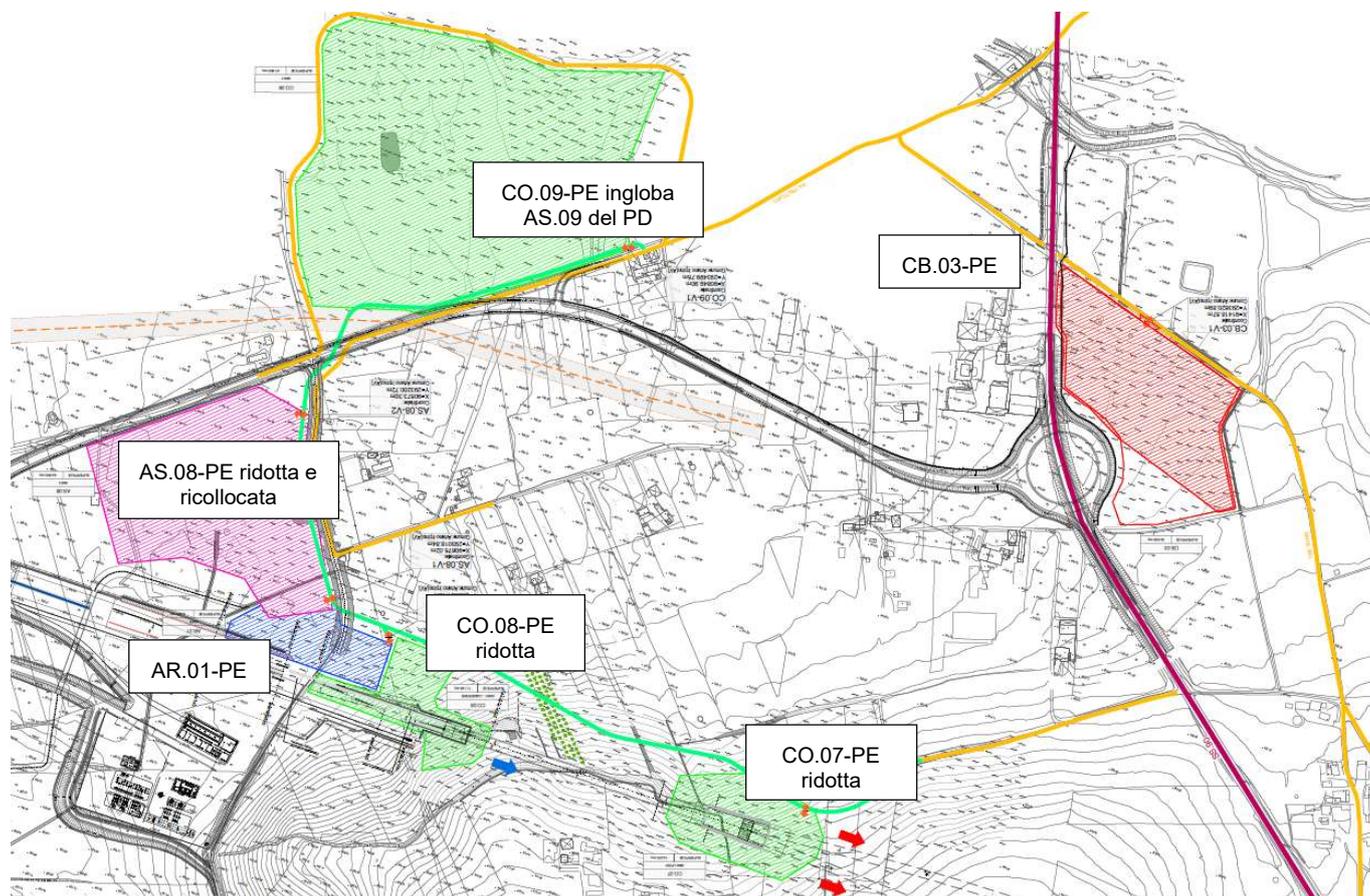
Ubicazione area di stoccaggio AS.08, cantiere base CB.03, cantieri operativi CO.07, CO.08 e CO.09, area armamento
